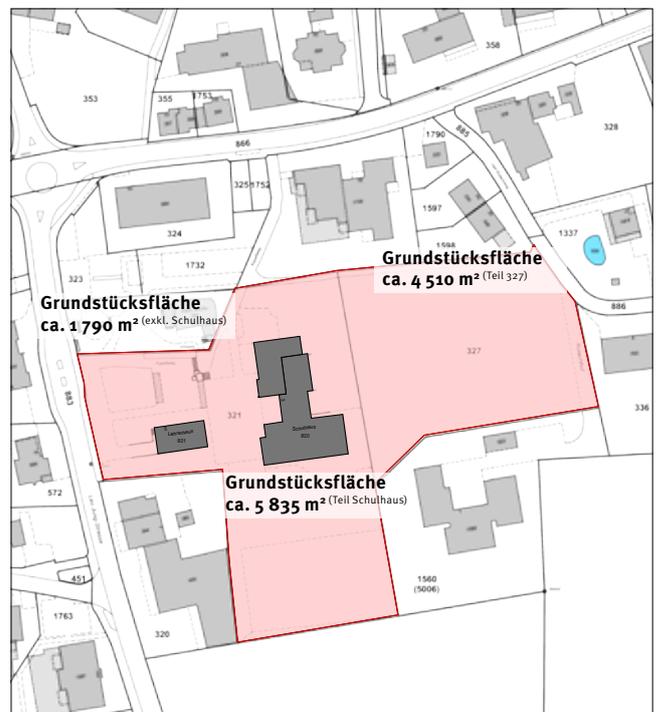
Situationsplan Zuckenriet, inkl. Flächenangaben
